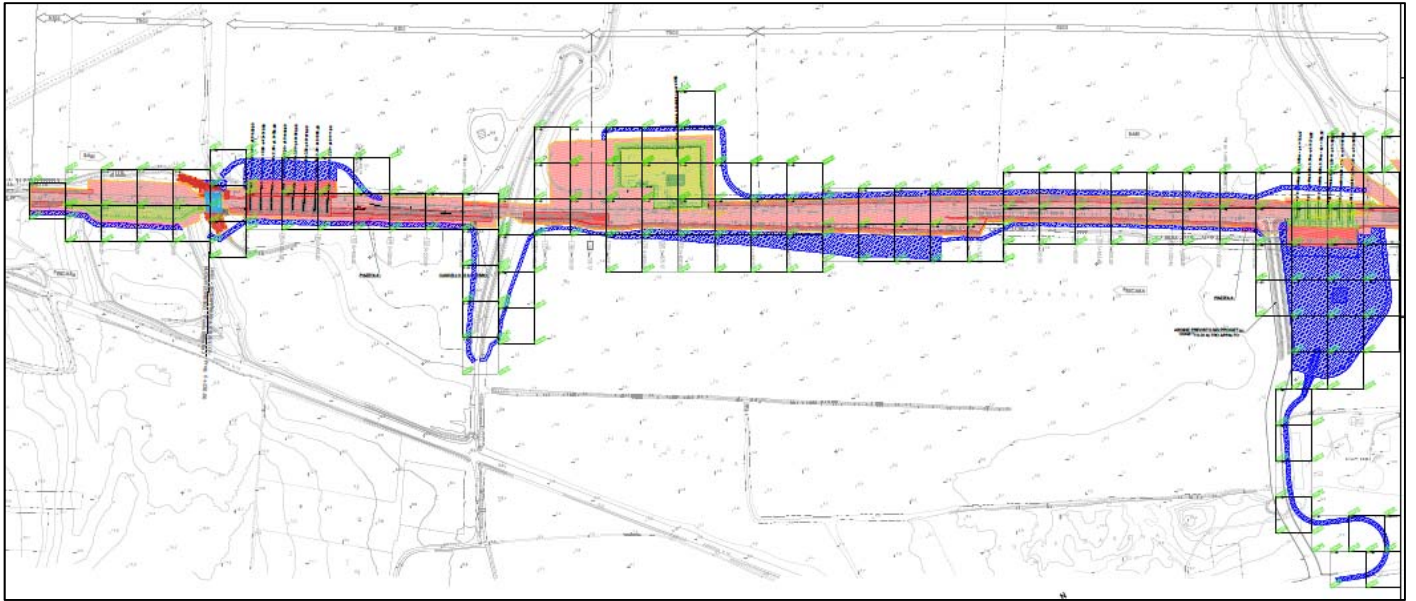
Stralcio Planimetrico tav1/4 delle aree da assoggettare a B.O.E:
